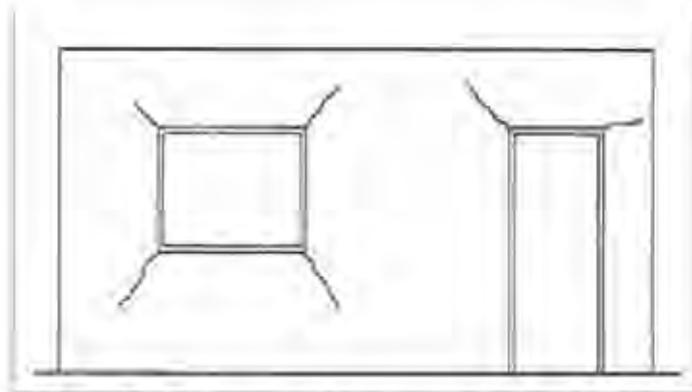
Fissuras em aberturas nas paredes de tijolos.
